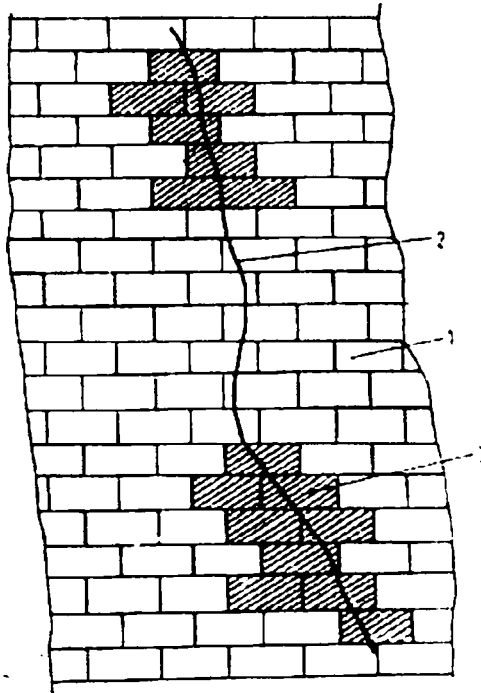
Cusaturi cu strepi de beton ; 1- perete portant ; 2- fisura in perete ; 3) strepi de beton .
